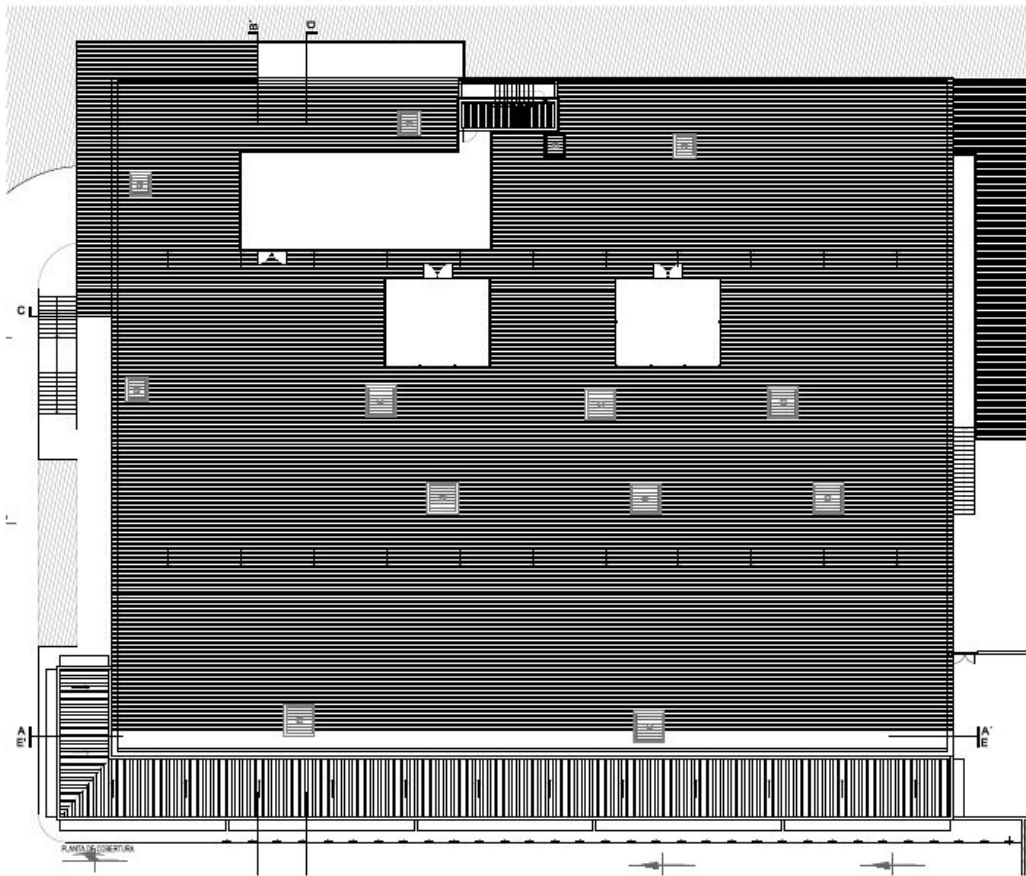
Planta de arquitetura do piso 1 (Cobertura)
